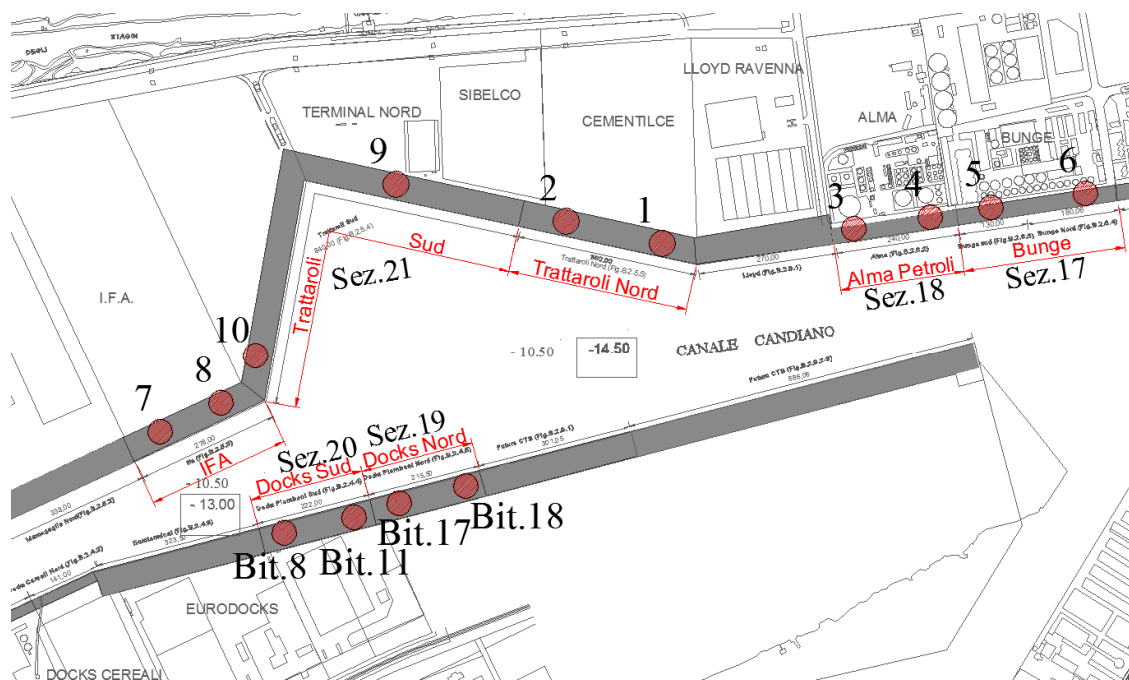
Stralcio planimetrico con posizione indicativa dei siti di indagine del PD
